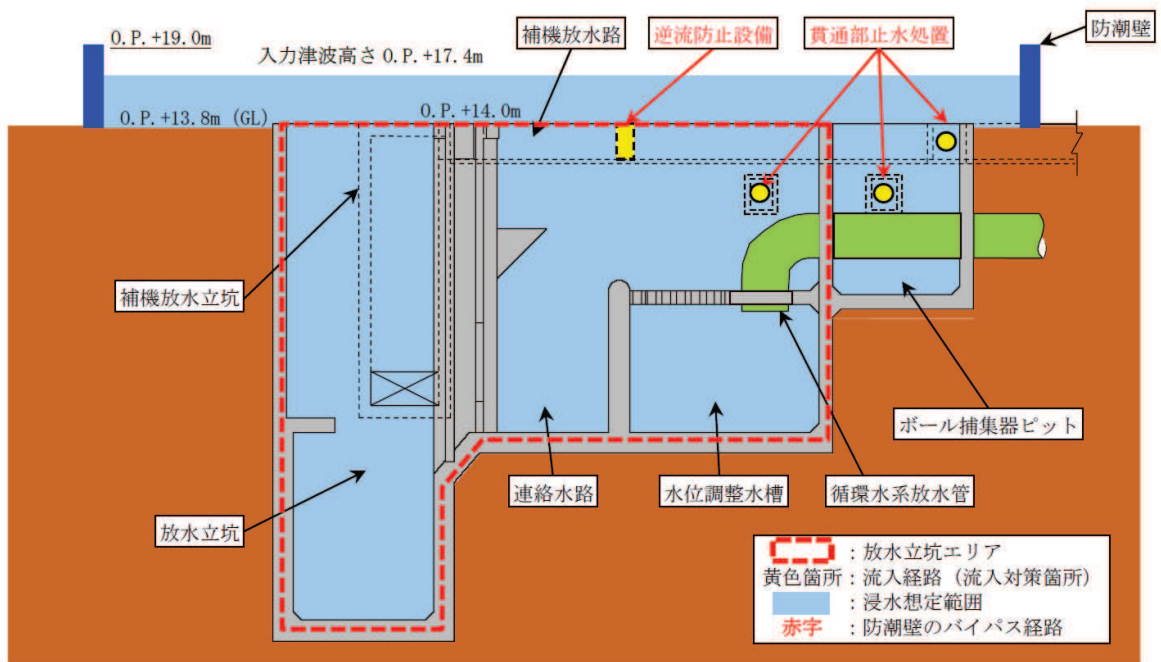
第 2 号機 放水立坑 流入対策配置図 (B-B 断面図)
